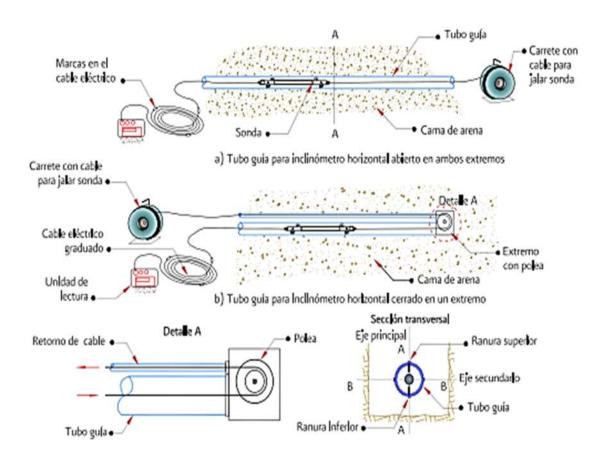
III.3.3.2.3 Componentes del inclinómetro horizontal.
